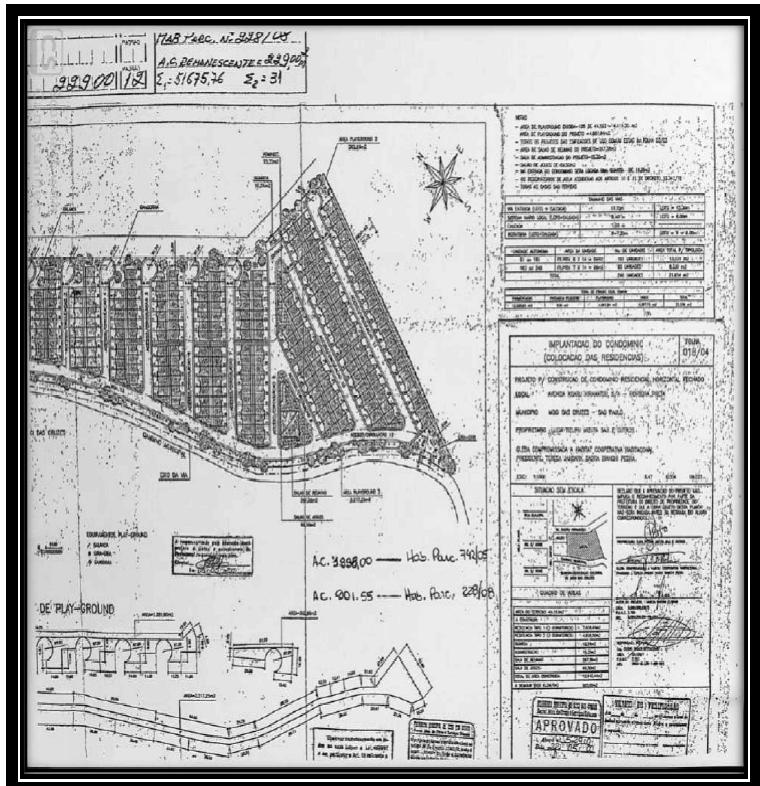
Planta de projeto de loteamento em parte da área constrita dos presentes autos.
